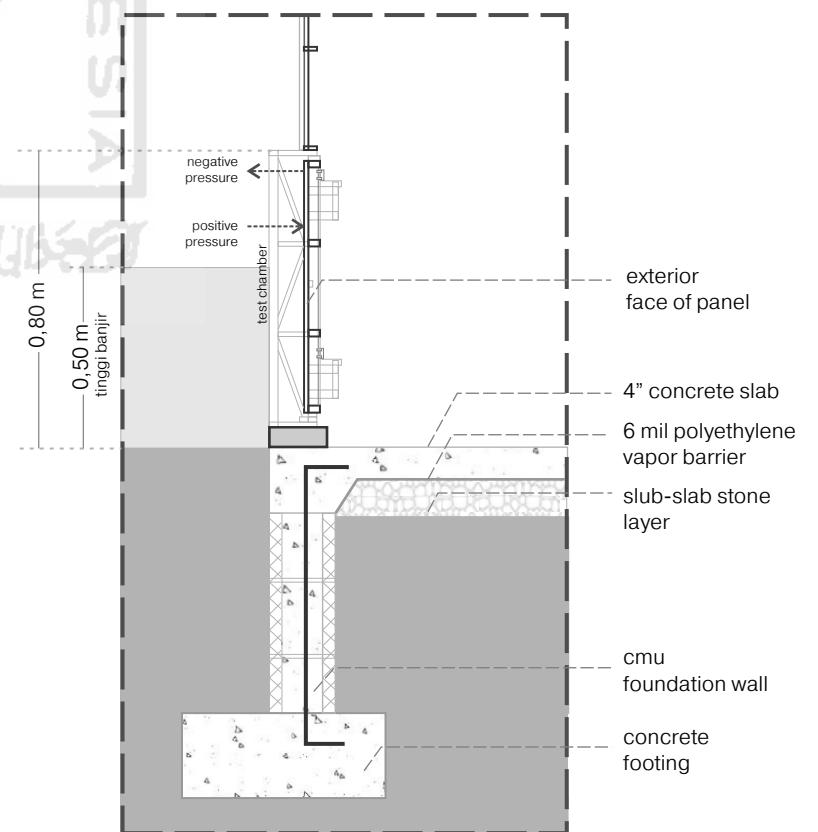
Kondisi site (Sumber: Penulis, 2021)
